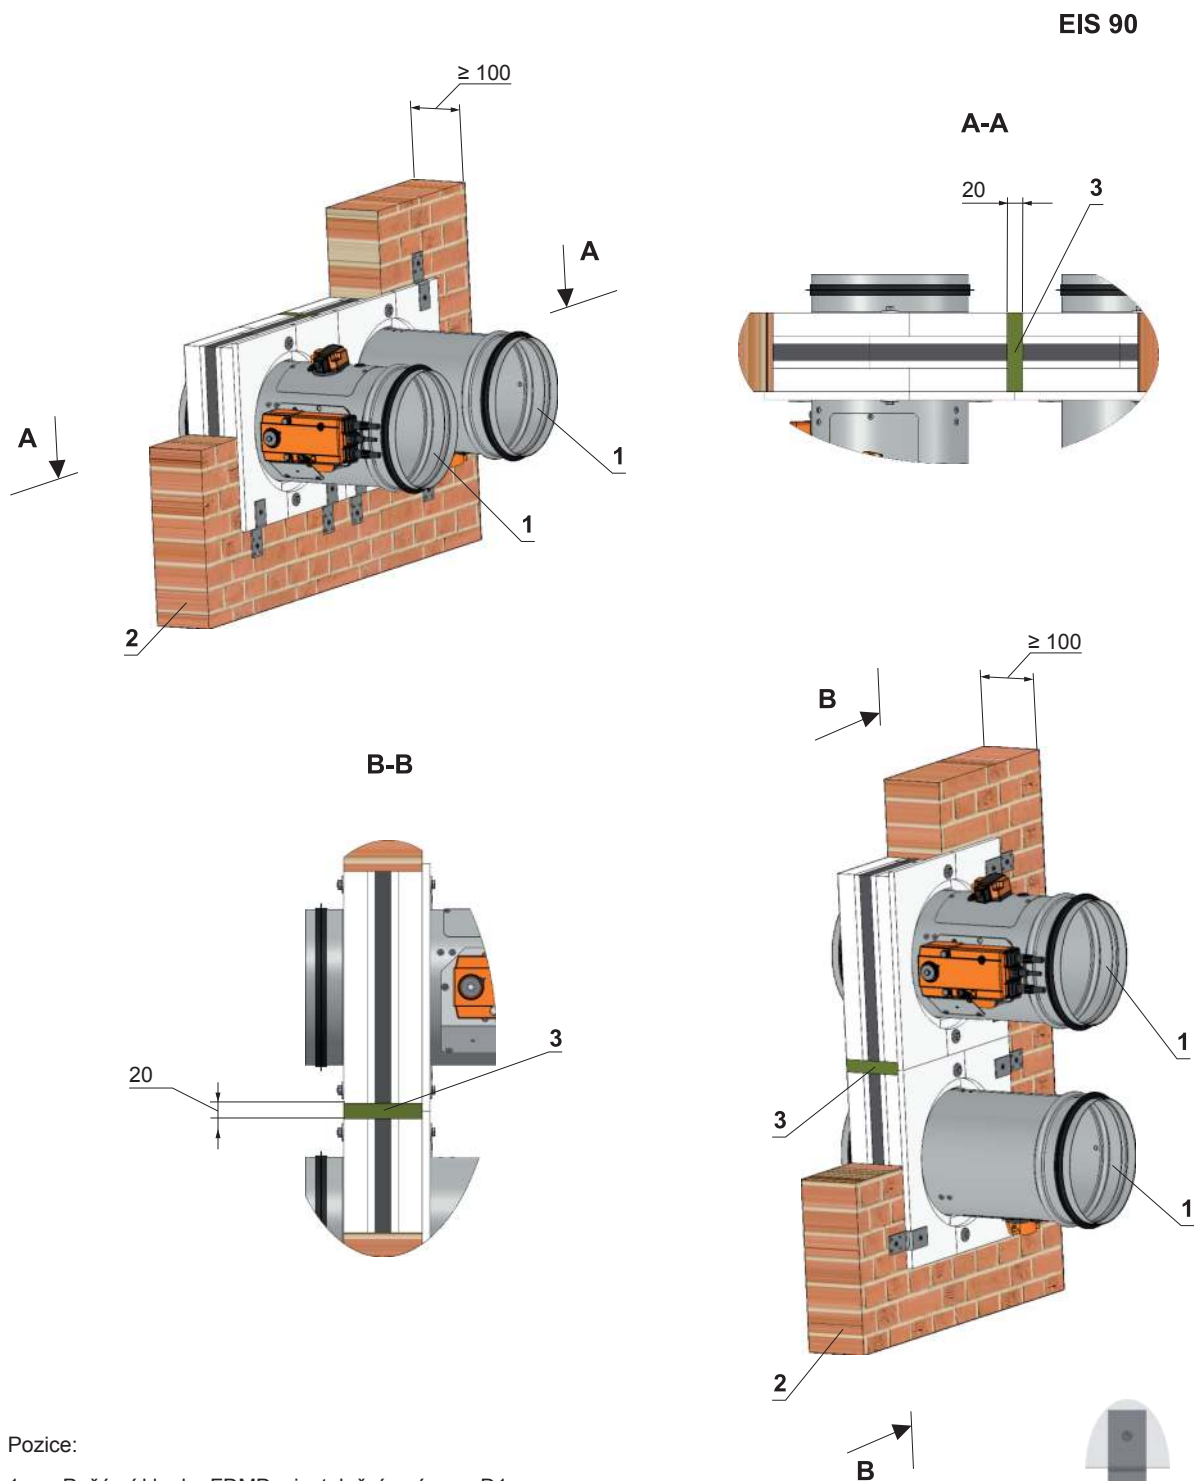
Tuhá stěnová konstrukce - zabudování u stěny, stropu - instalační rám D5
